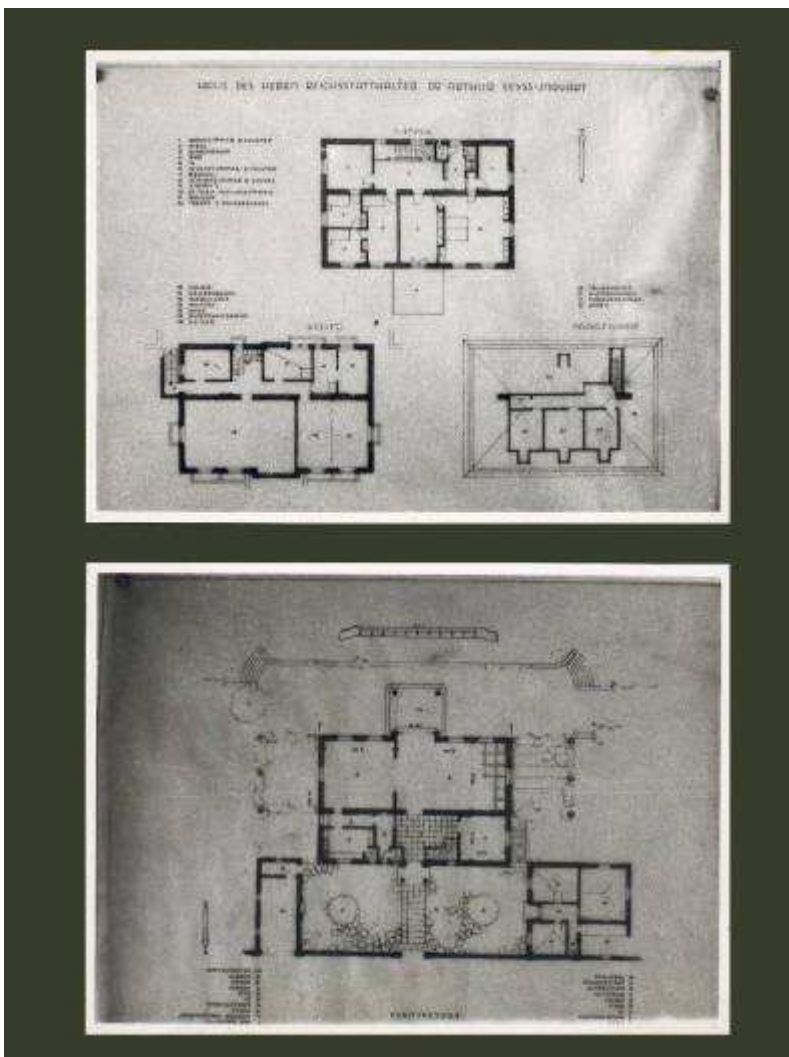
Otto Strohmayr, oben: Grundriss Keller, 1. Stock und Dachgeschoss, unten: Erdgeschoss, Haus Seyss-Inquart, Wien, undatiert (Sammlung Fais-Månsson).
